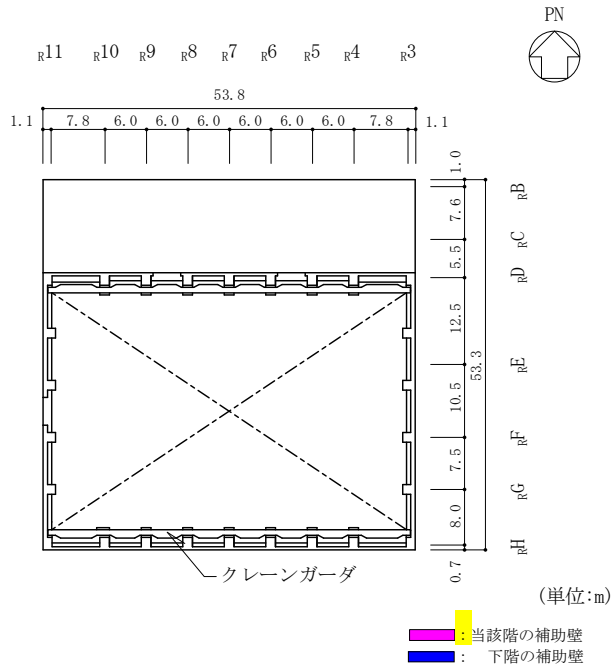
(7) 補助壁の配置図 (EL 51.7m)
